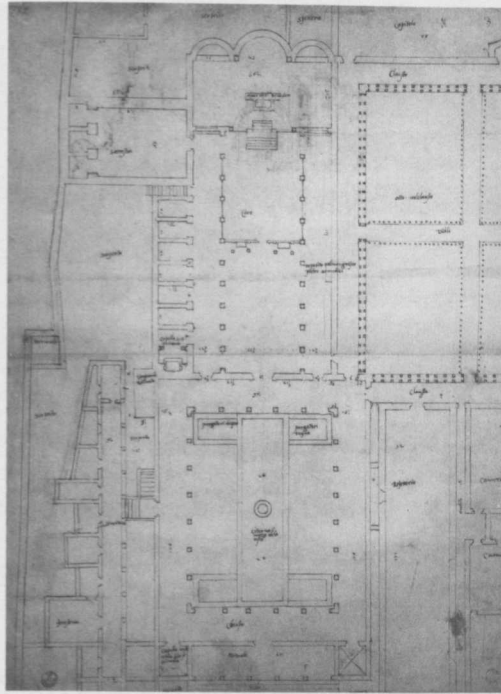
Grundrisszeichnung des Klosters Montecassino von Antonio und Giovanni Battista da Sangallo (Uffizien, Florenz)
